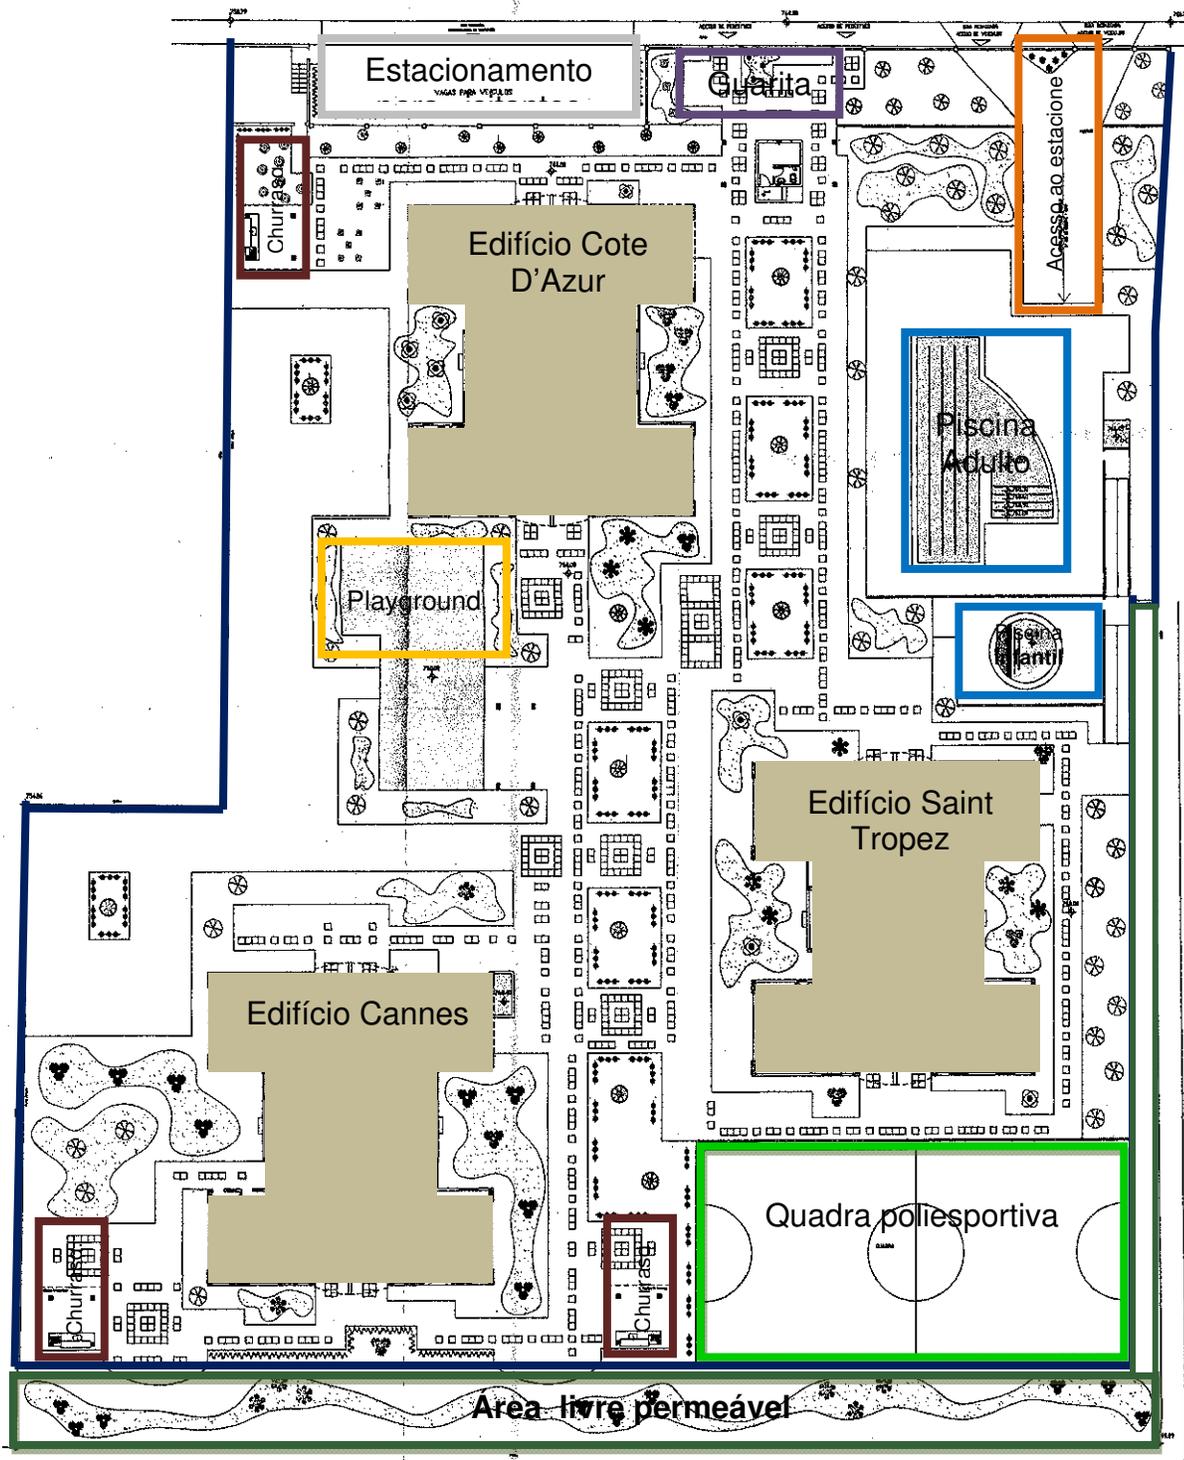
Implantação do Condomínio Ville Méditerranée. Fonte: a partir da planta de paisagismo.
